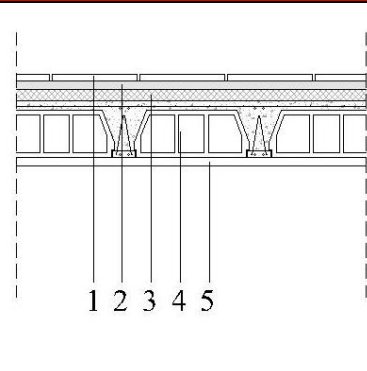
Planimetría EO de tipología de divisiones horizontales. Fuente: Elaboración propia.
